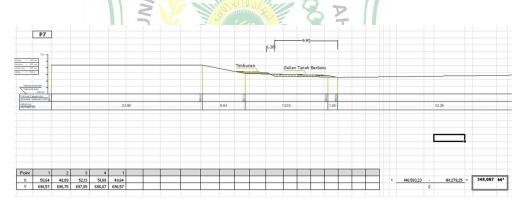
Potongan memanjang Sungai Ulu Masang
